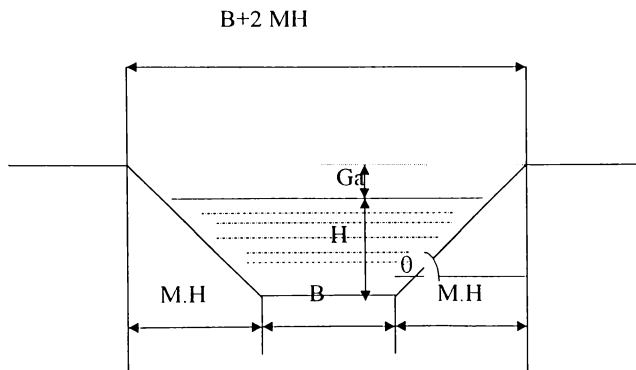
Secțiune transversală trapezoidală, cu elementele geometrice caracteristice
